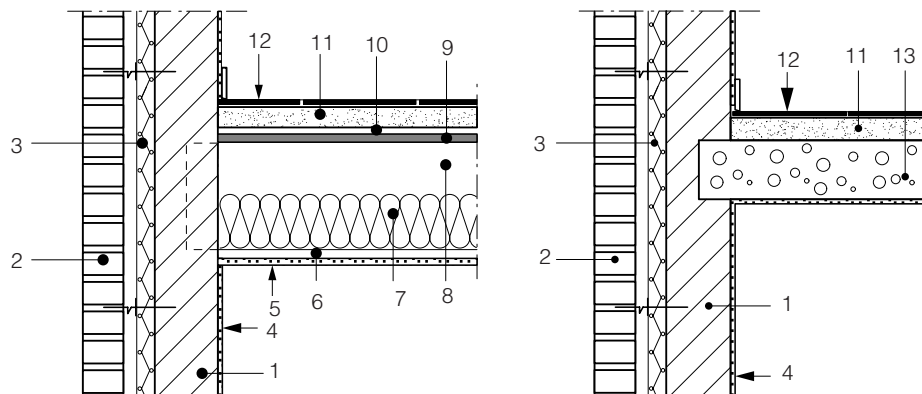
Structure d'un plancher en béton (à droite) et d'un plancher en bois (à gauche) dans un mur en blocs de béton.
